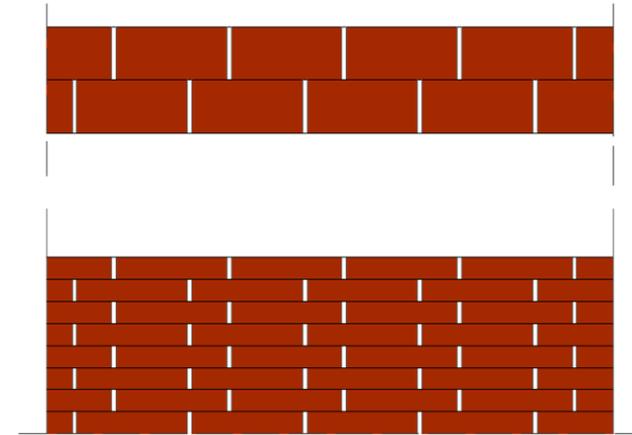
Detalle aparejo muro de ladrillo, Fuente: autor propio
